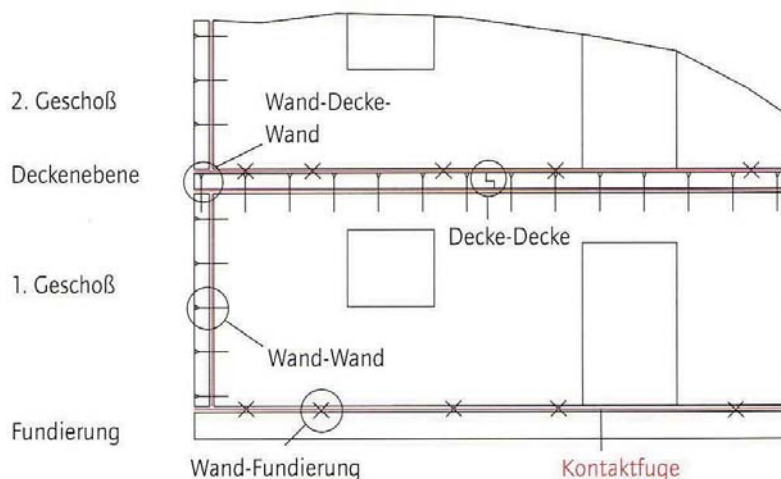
Lage von Kontaktfugen bei mehrgeschossigen Gebäuden<sup>132</sup>
